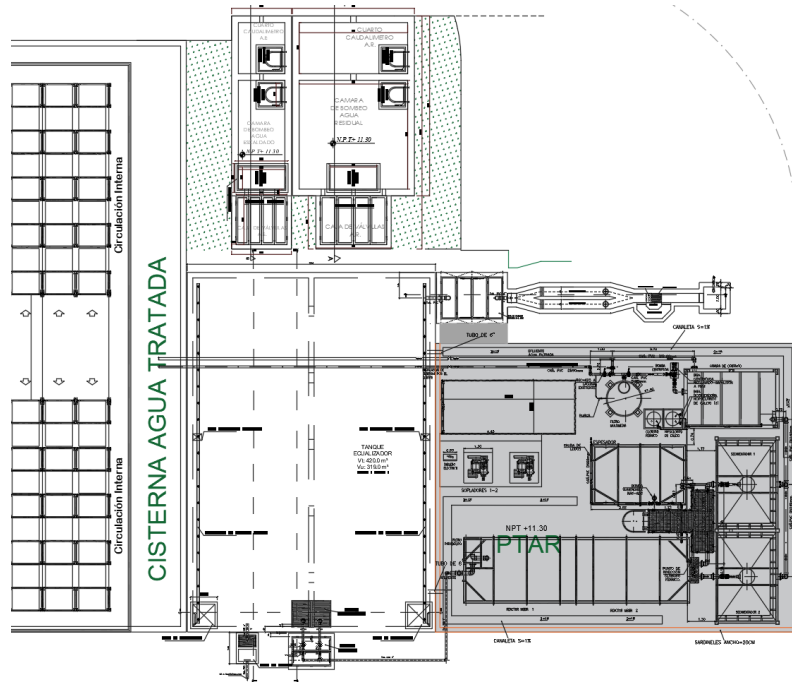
Vista en planta del sistema de tratamiento de agua residual TALSA.
